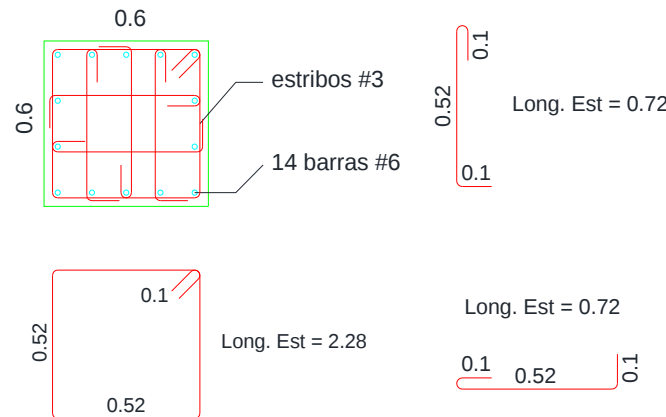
Detalle sección trasversal de una columna de 60 x 60. Aplicativo Ultimate Columns 2.0
